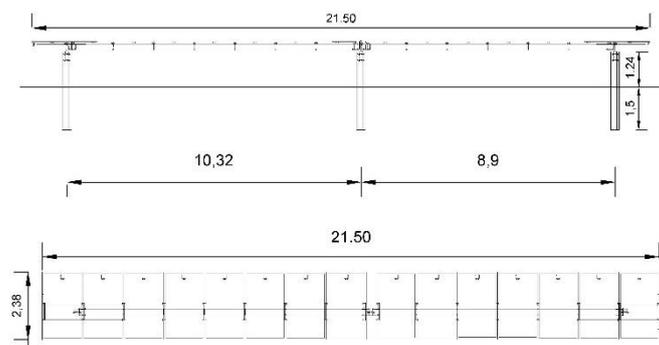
Prospetto frontale e vista in pianta delle strutture (15 moduli) ad inclinazione 0°
